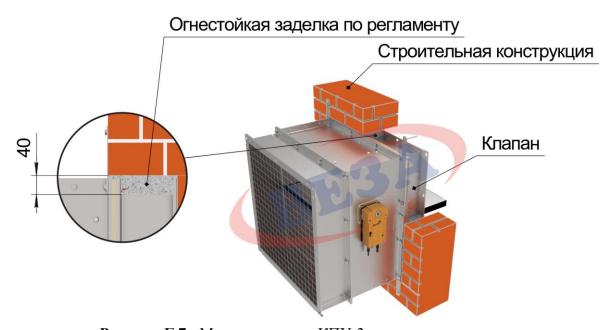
Монтаж клапана КПУ-3 в стеновое перекрытие
